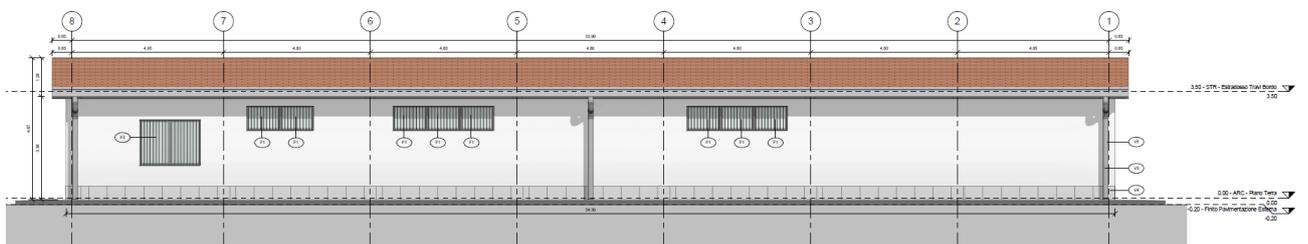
GA Nord – Prospetto Ovest (Lato Binari)
